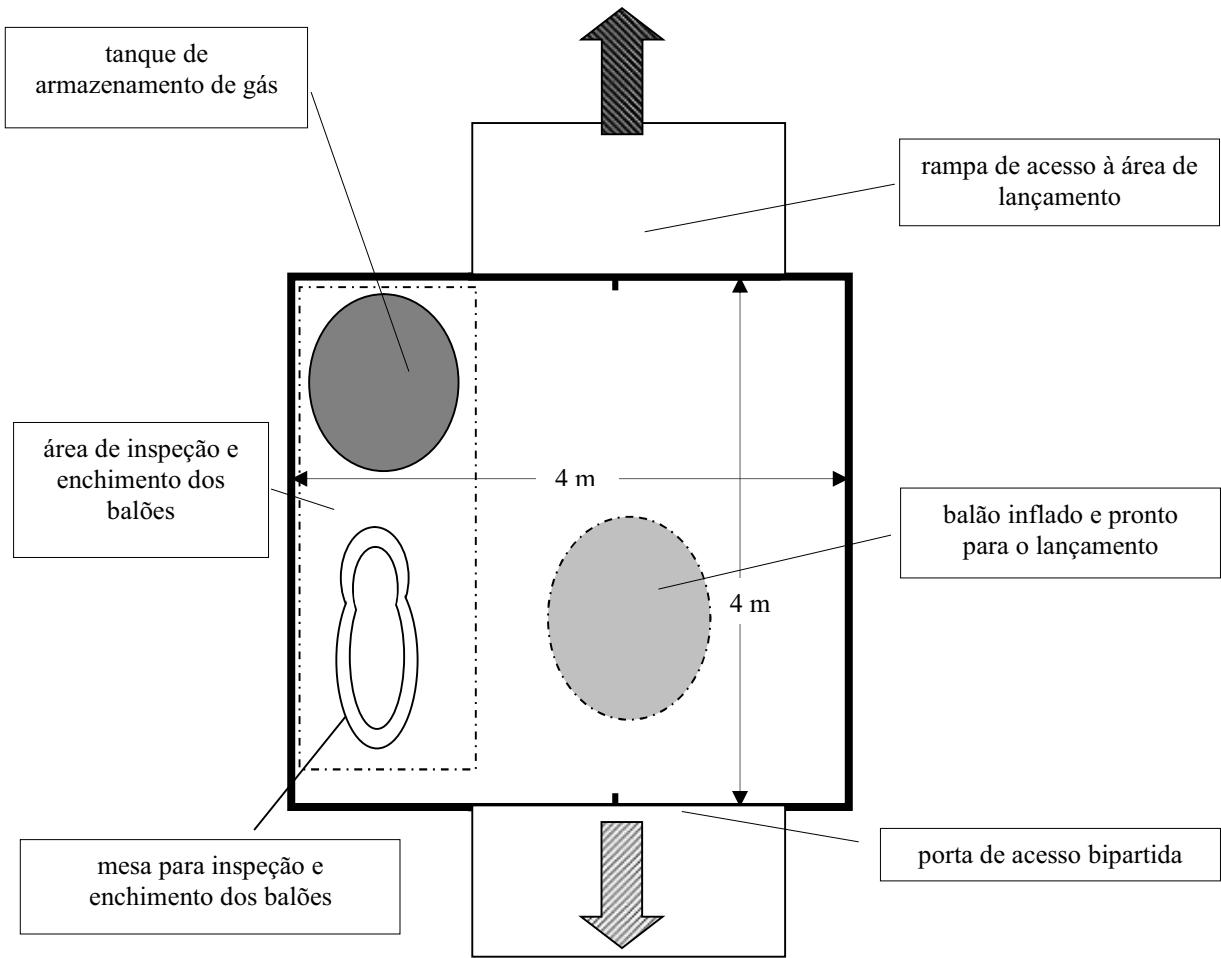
Sugestão para o Módulo de Armazenamento de Gás e Enchimento de Balões
